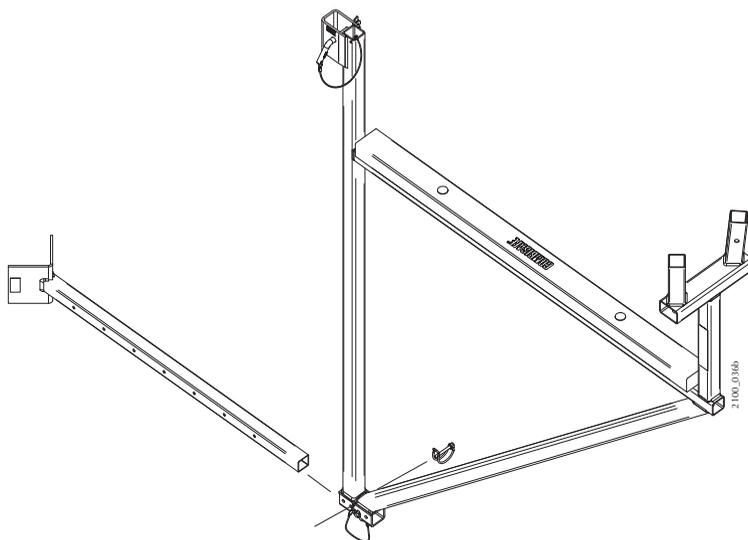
Монтаж дополнительной оснастки угловой площадки
